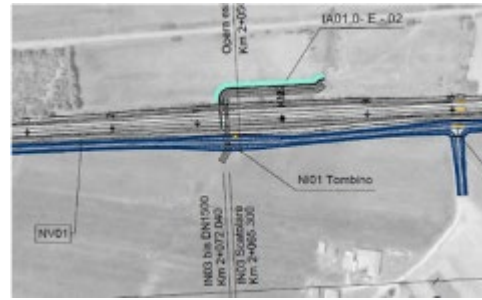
IN03 – Stralcio planimetrico opere a verde revisionato
